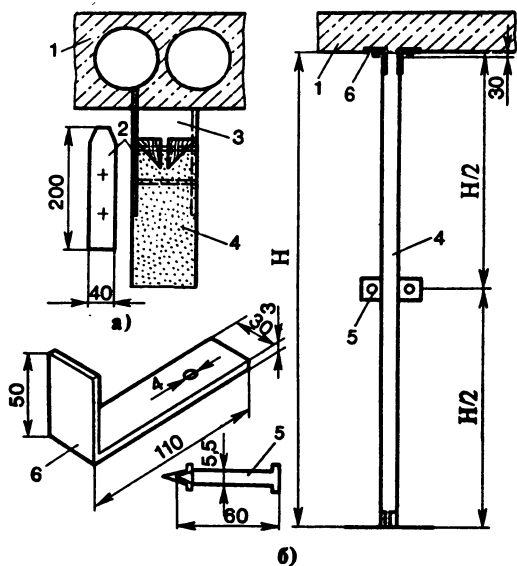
Крепление панельных перегородок к перекрытию: а — пластинами к плитам, б — угольниками и дюбелями; 1 — плита перекрытия; 2 — стальная пластина, 3 — зазор между перегородкой и перекрытием (прогоном), 4 — перегородка, 5 — дюбель, 6 — угольники
